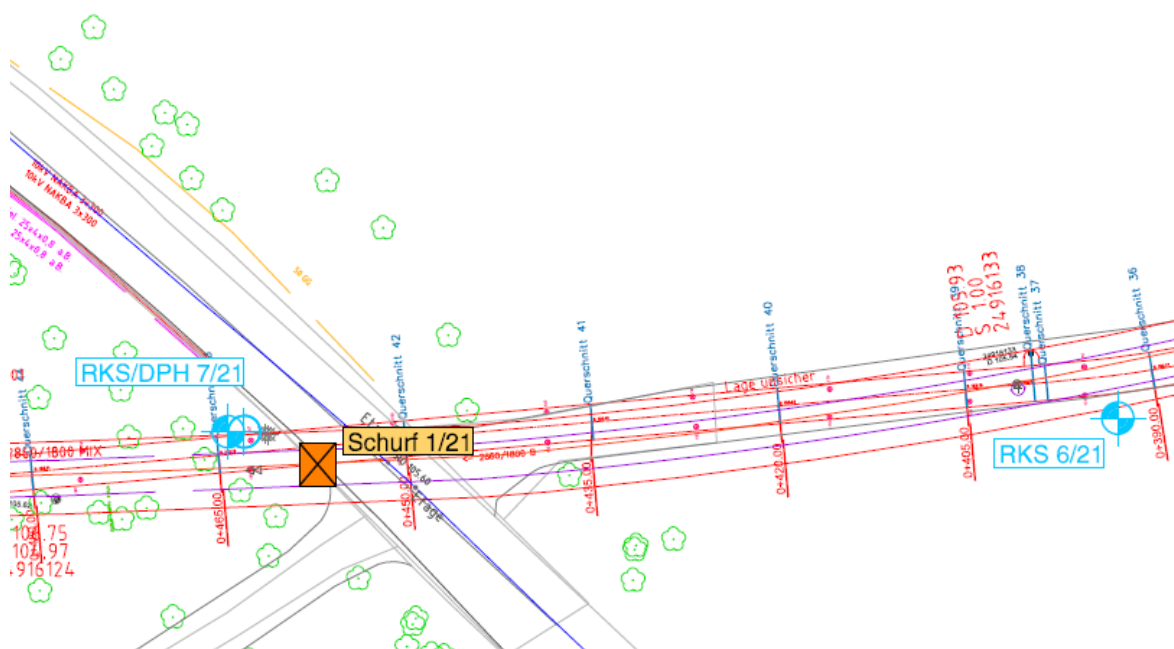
Ausschnitt Lageplan mit den Orten geotechnischer Aufschlüsse, entnommen aus Anlage 1 der Unterlage [13]
